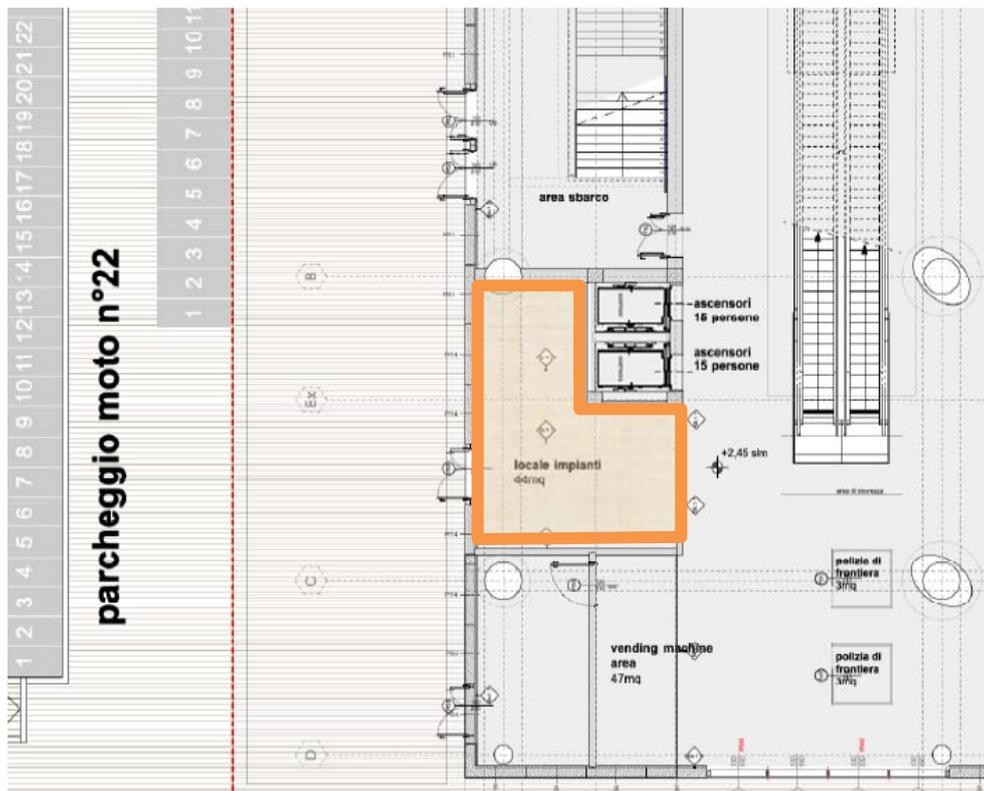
Piano terra, lato nord: locale impianti (planimetria), superfici a parete ed a soffitto di trattamento acustico su cui si deve applicare il materiale fonoassorbente
